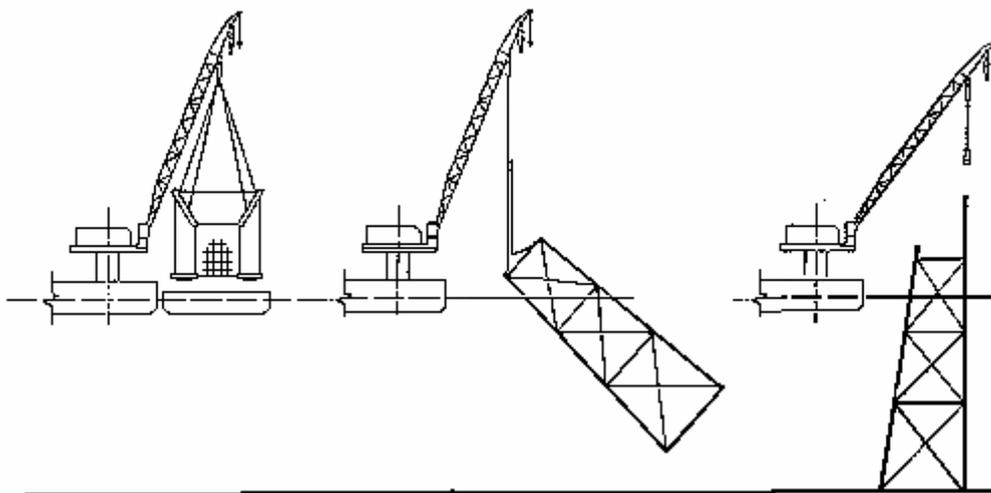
a - Schema di Installazione del Jacket
